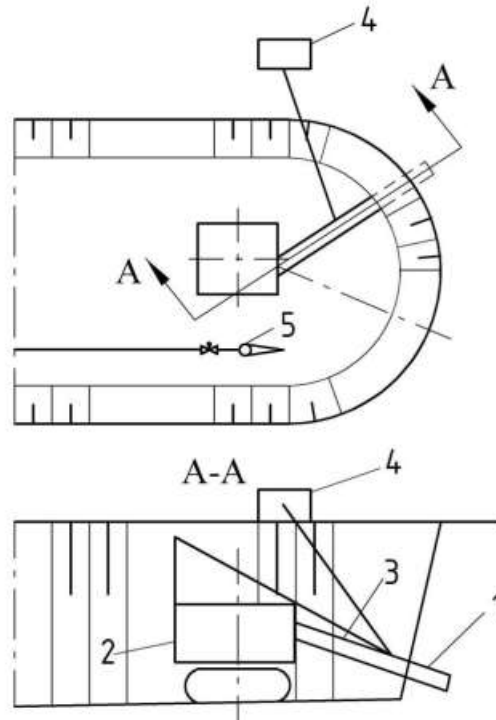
Схема подрезки уступа баром: 1 – подрезной бар; 2 – бульдозер; 3 – штанга; 4 – лебедка; 5 – гидромонитор
